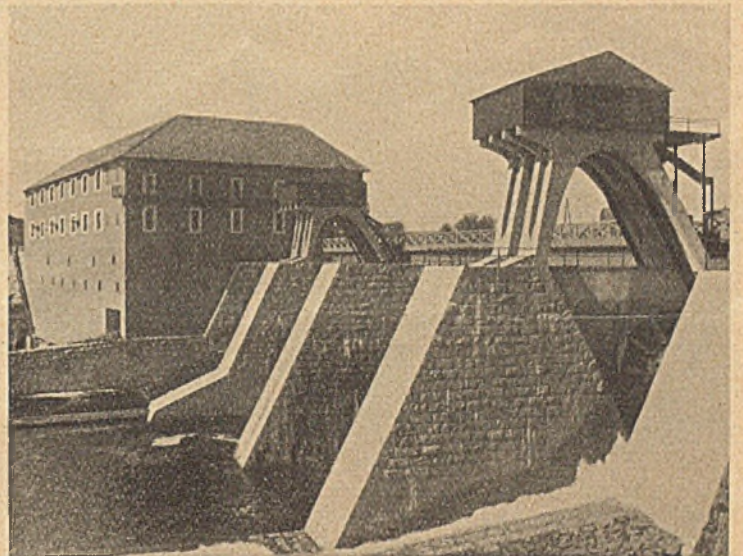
Walzenwehranlage am Dalälven (Schweden).
